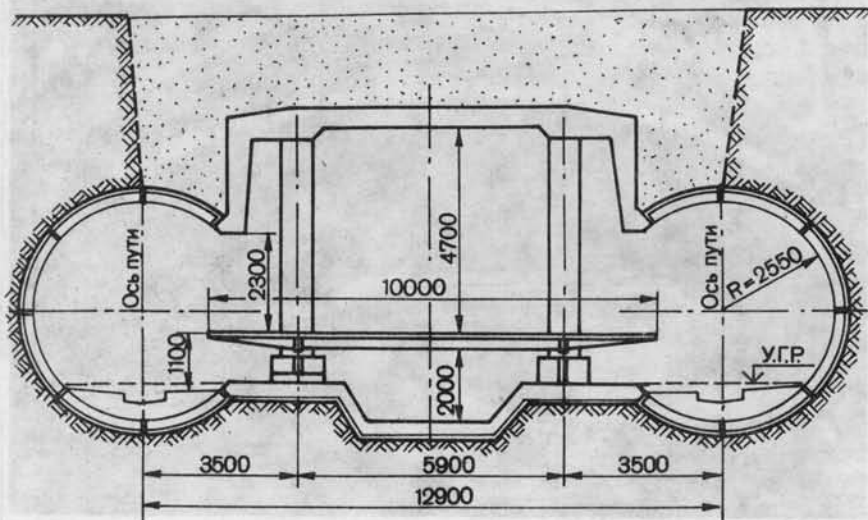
Конструкция колонной станции с плоским консольным перекрытием.
